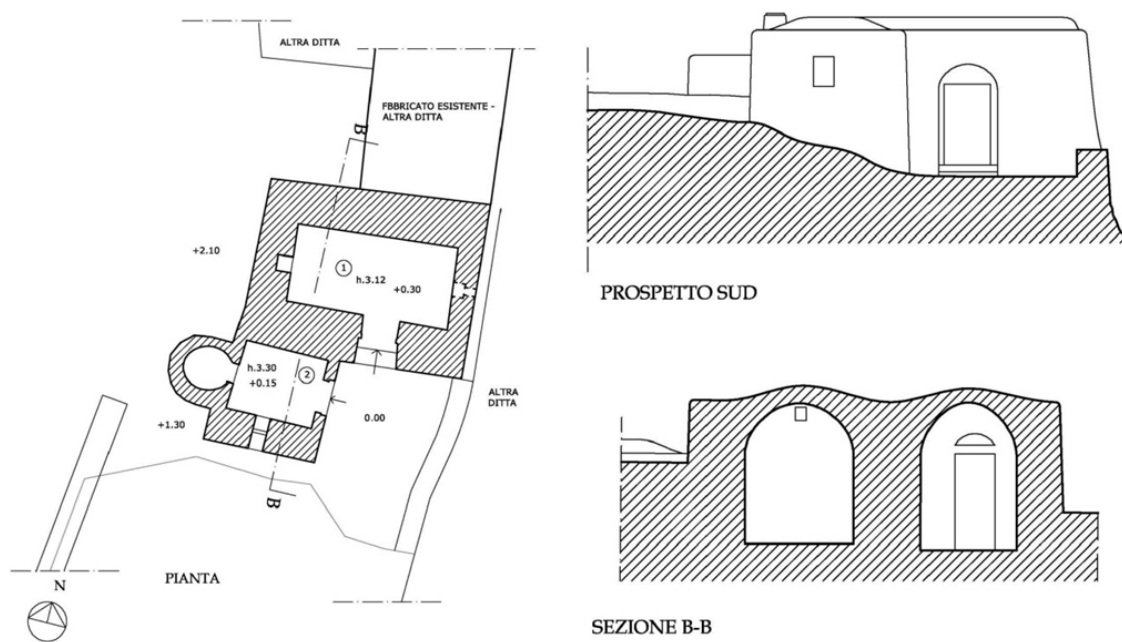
Imagem de planta corte e alçado sul, escala 1:100 (imagem fora de escala) (Cedida por Arq. G. Bonomo).
